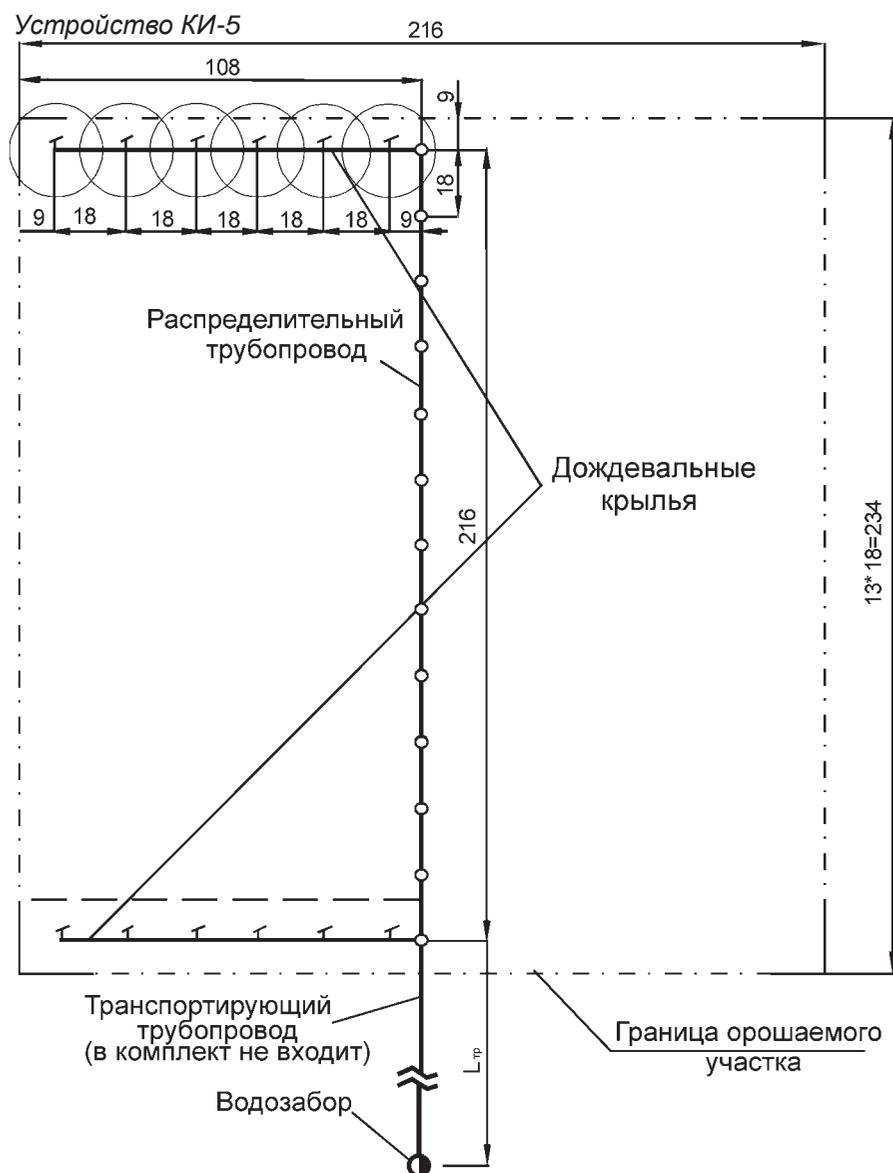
Типовая схема монтажа комплекта КИ-5
